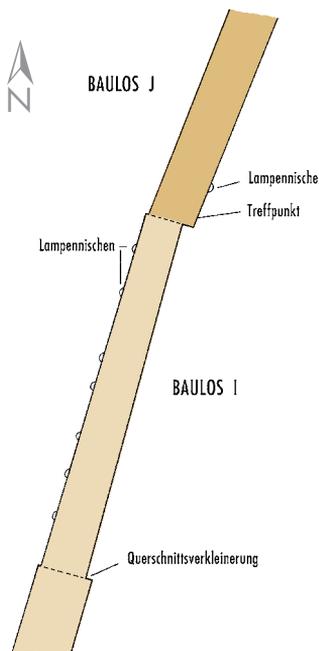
Detail: Treffpunkt Baulos I und J. M. 1:100.
